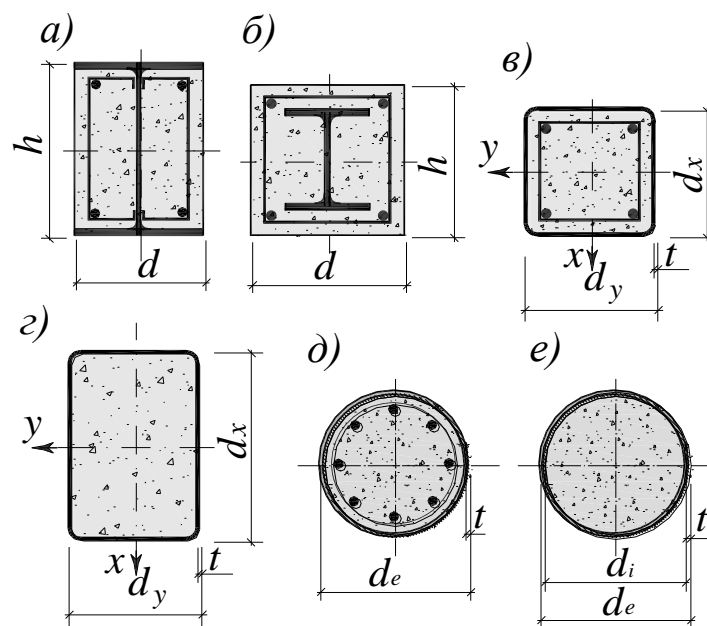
Основні типи поперечних перерізів сталобетонних елементів.
